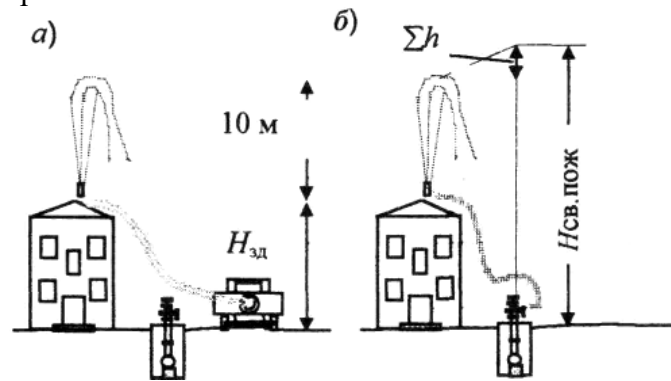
Схемы тушения пожара из водопровода: а - низкого давления; б - высокого давления
